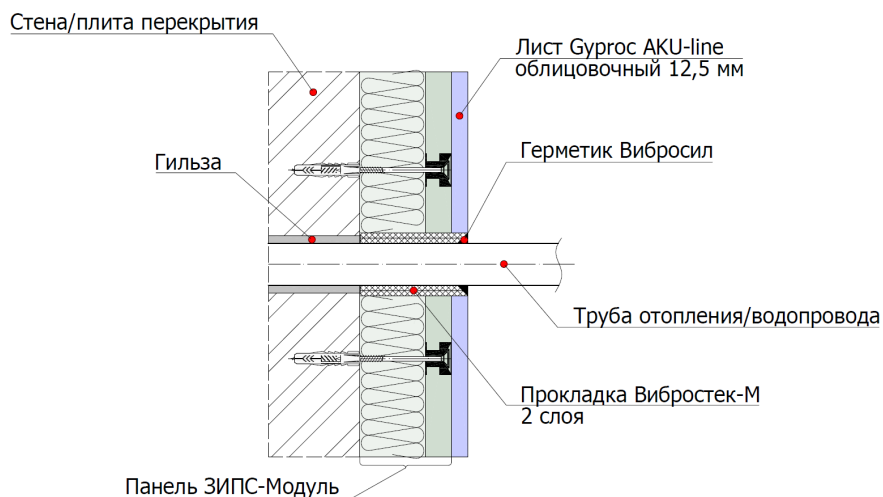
Схема пропуска труб отопления/водопровода через конструкцию звукоизоляционной бескаркасной системы ЗИПС.
